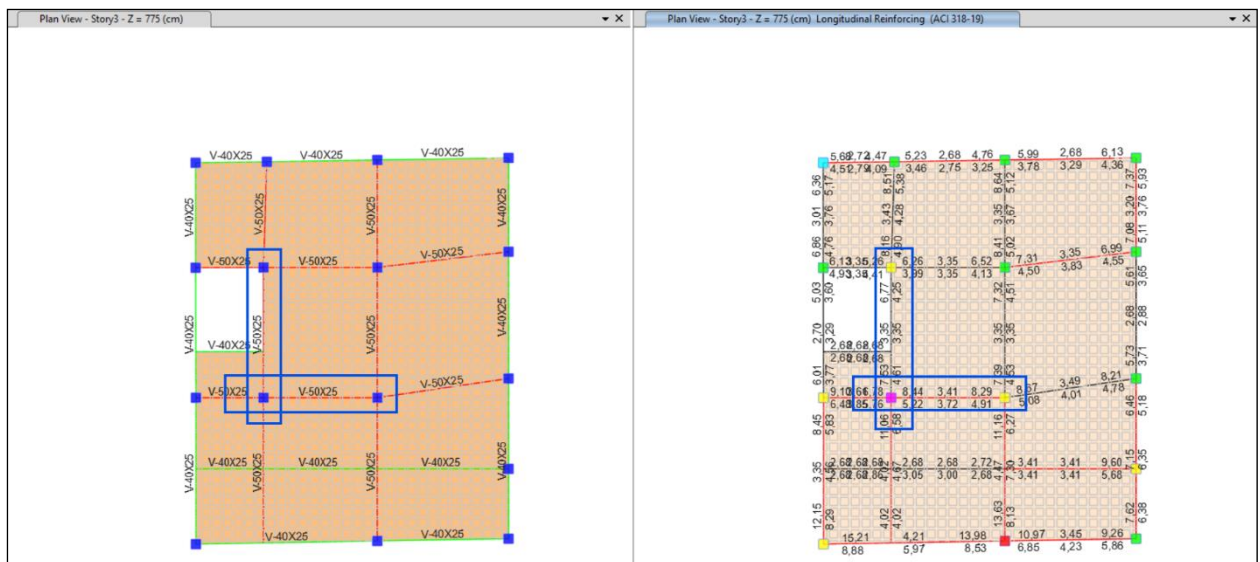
Acero a flexion en vigas de losa nivel 3, alternativa 1 [Autor]
